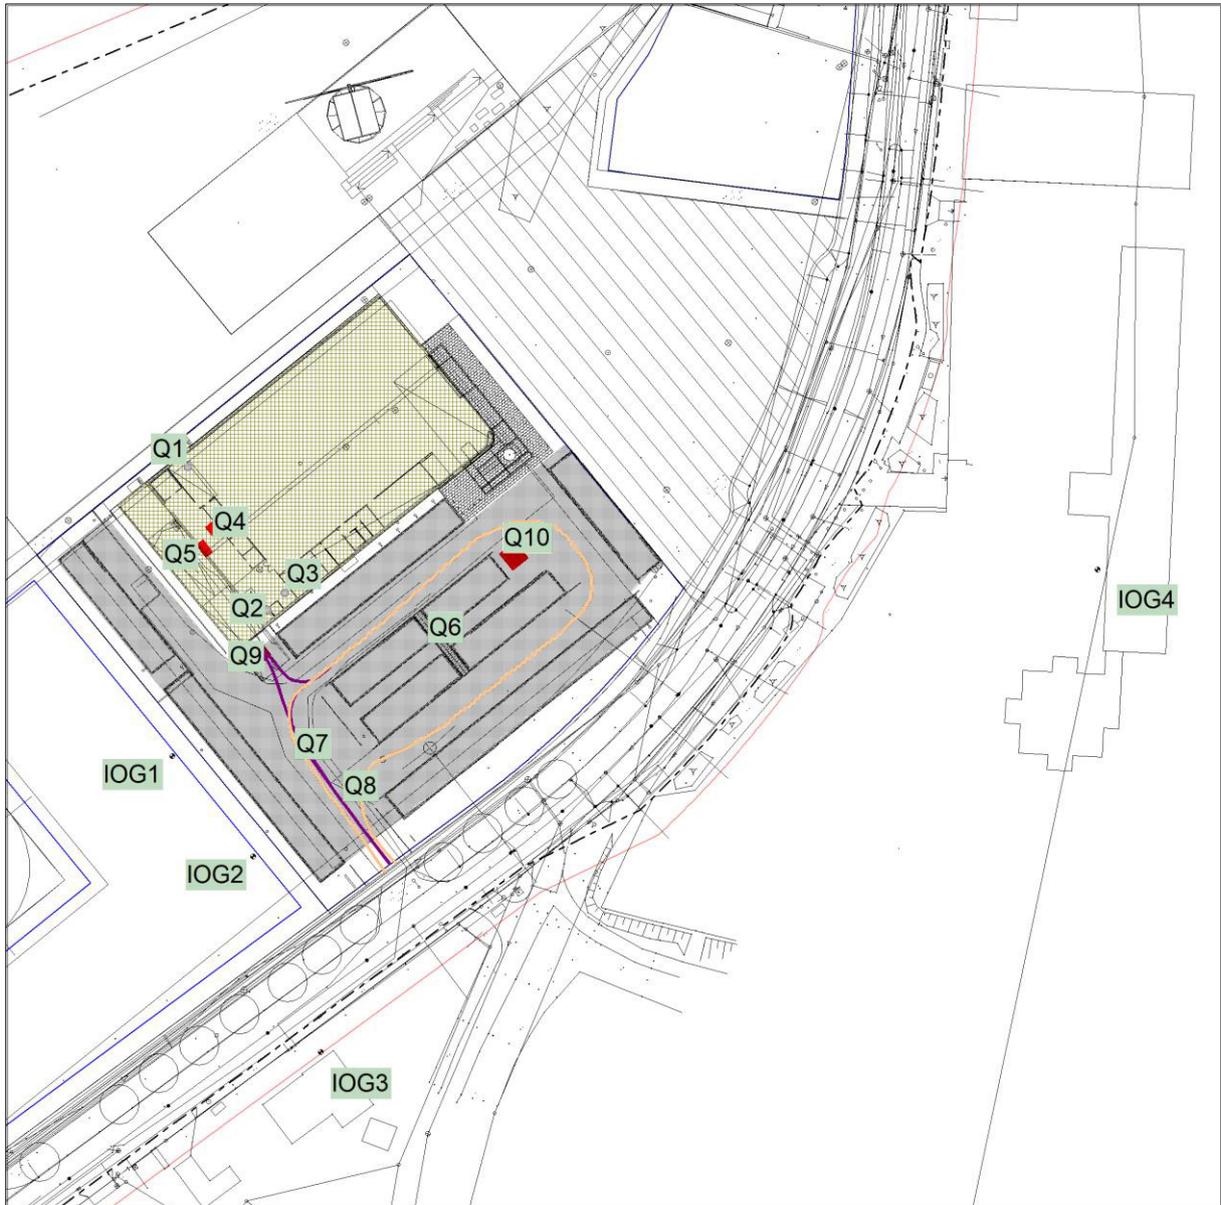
Lageplan Gewerbe mit Nachweisorten IOG
